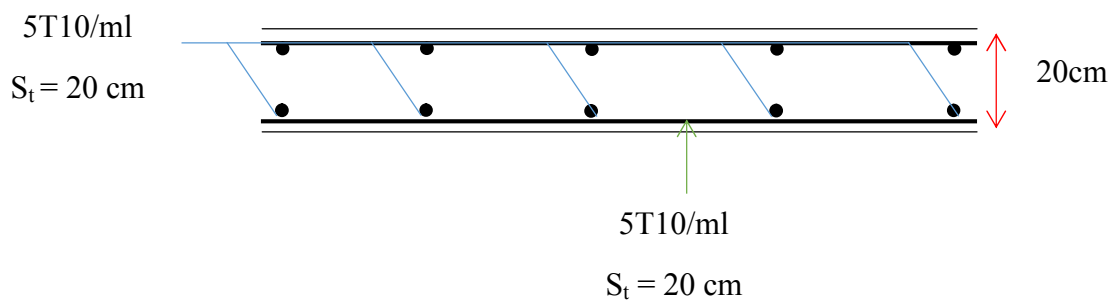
Coupe horizontale du ferrailage du voile périphérique en BO.
